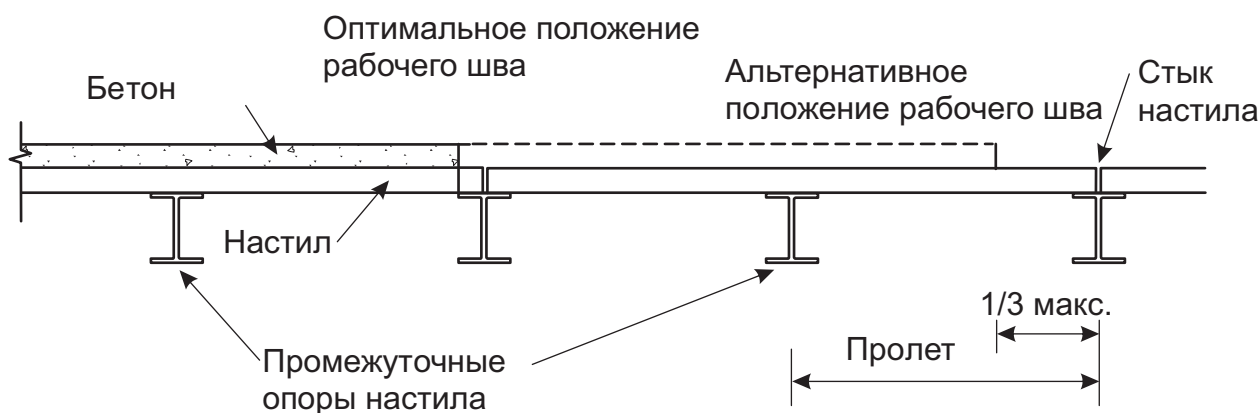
Рекомендуемое положение рабочих швов в бетонной плите
